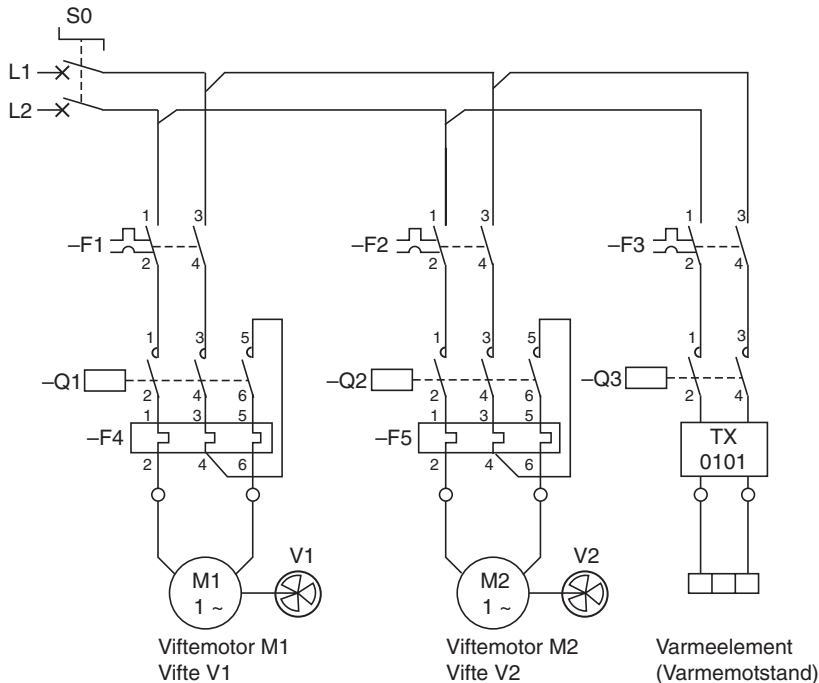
Arrangementstegning for den elektriske installasjonen og instrumenteringen
